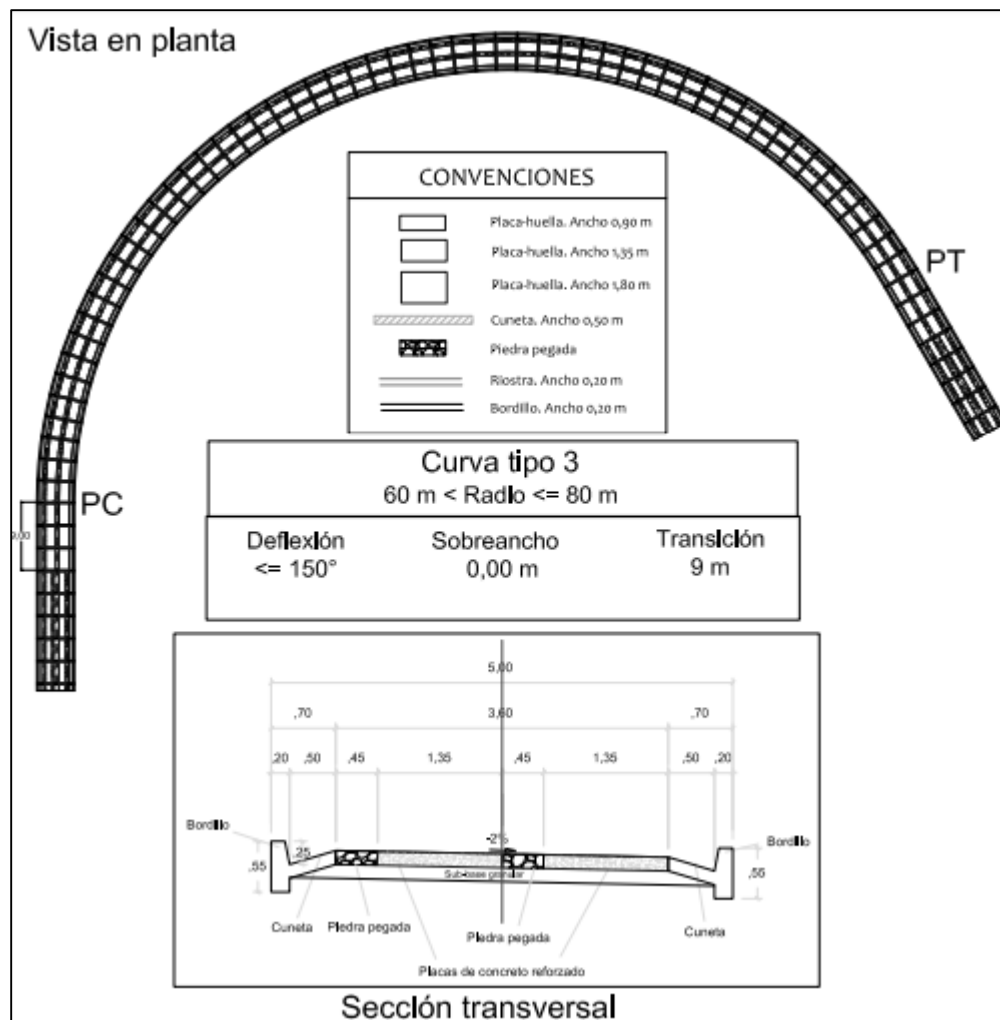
Diseño estructural con corte trasversal y vista en planta para el cuarto tramo, curva 2.
